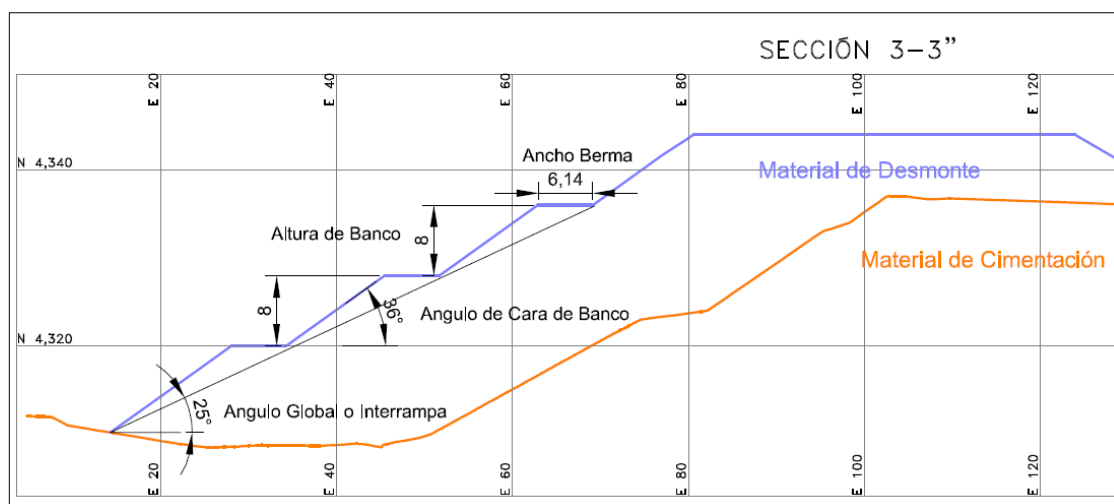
Parámetros de diseño de botadero. Fuente: Plan de minado año 2017 (CIEMSA, 2017)
